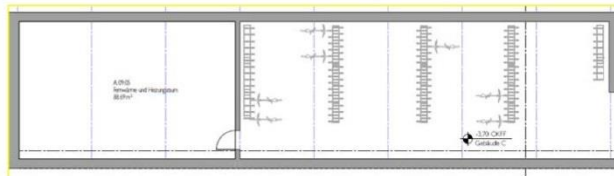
Auszug Planunterlagen, Grundriss Fahrradkeller
